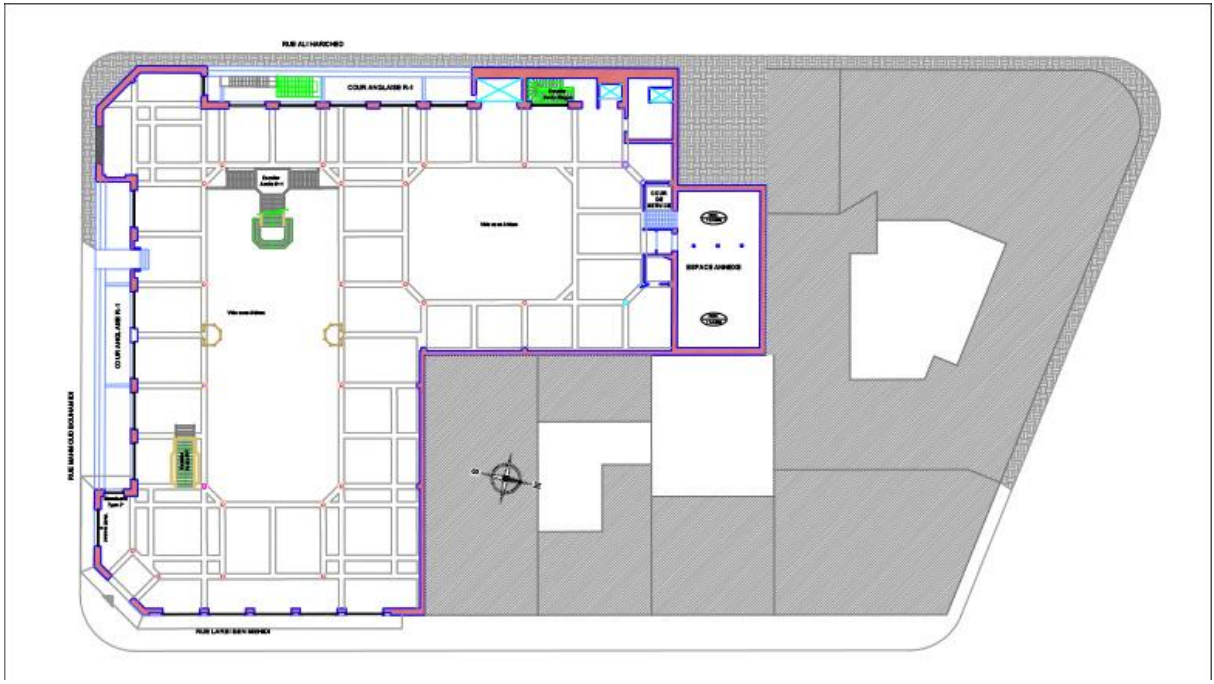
Plan du Rez De Chaussée des Galleries d'Alger
